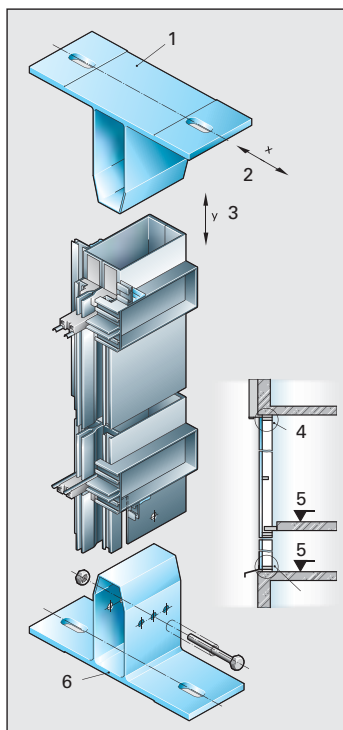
a) Montering av förtillverkade element b) Delningsprofil
